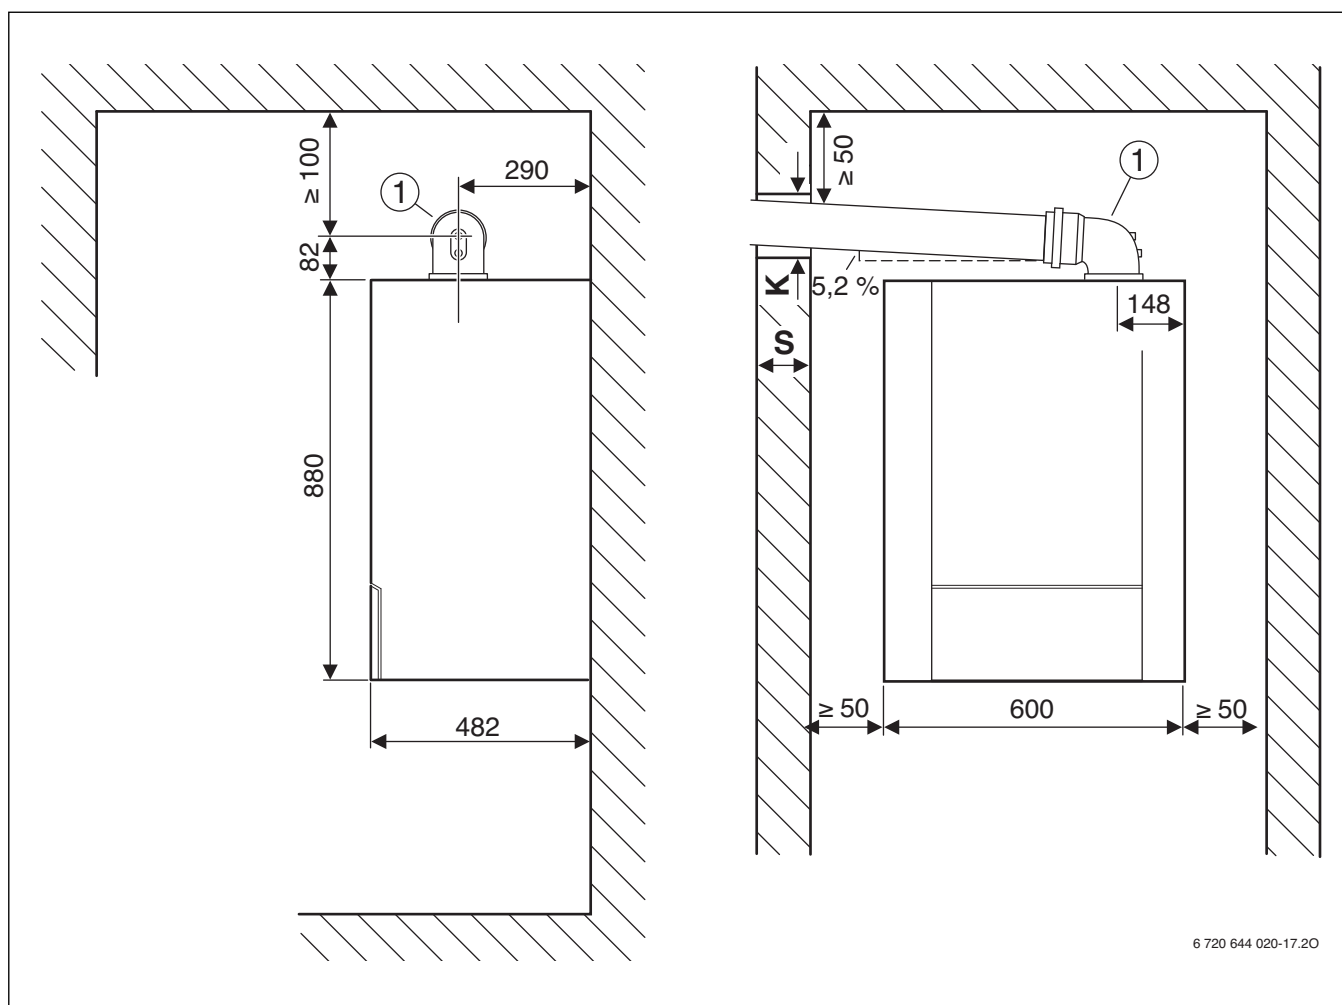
Conduits concentriques horizontaux Ø 80/125 mm ou conduit Ø 80 mm
